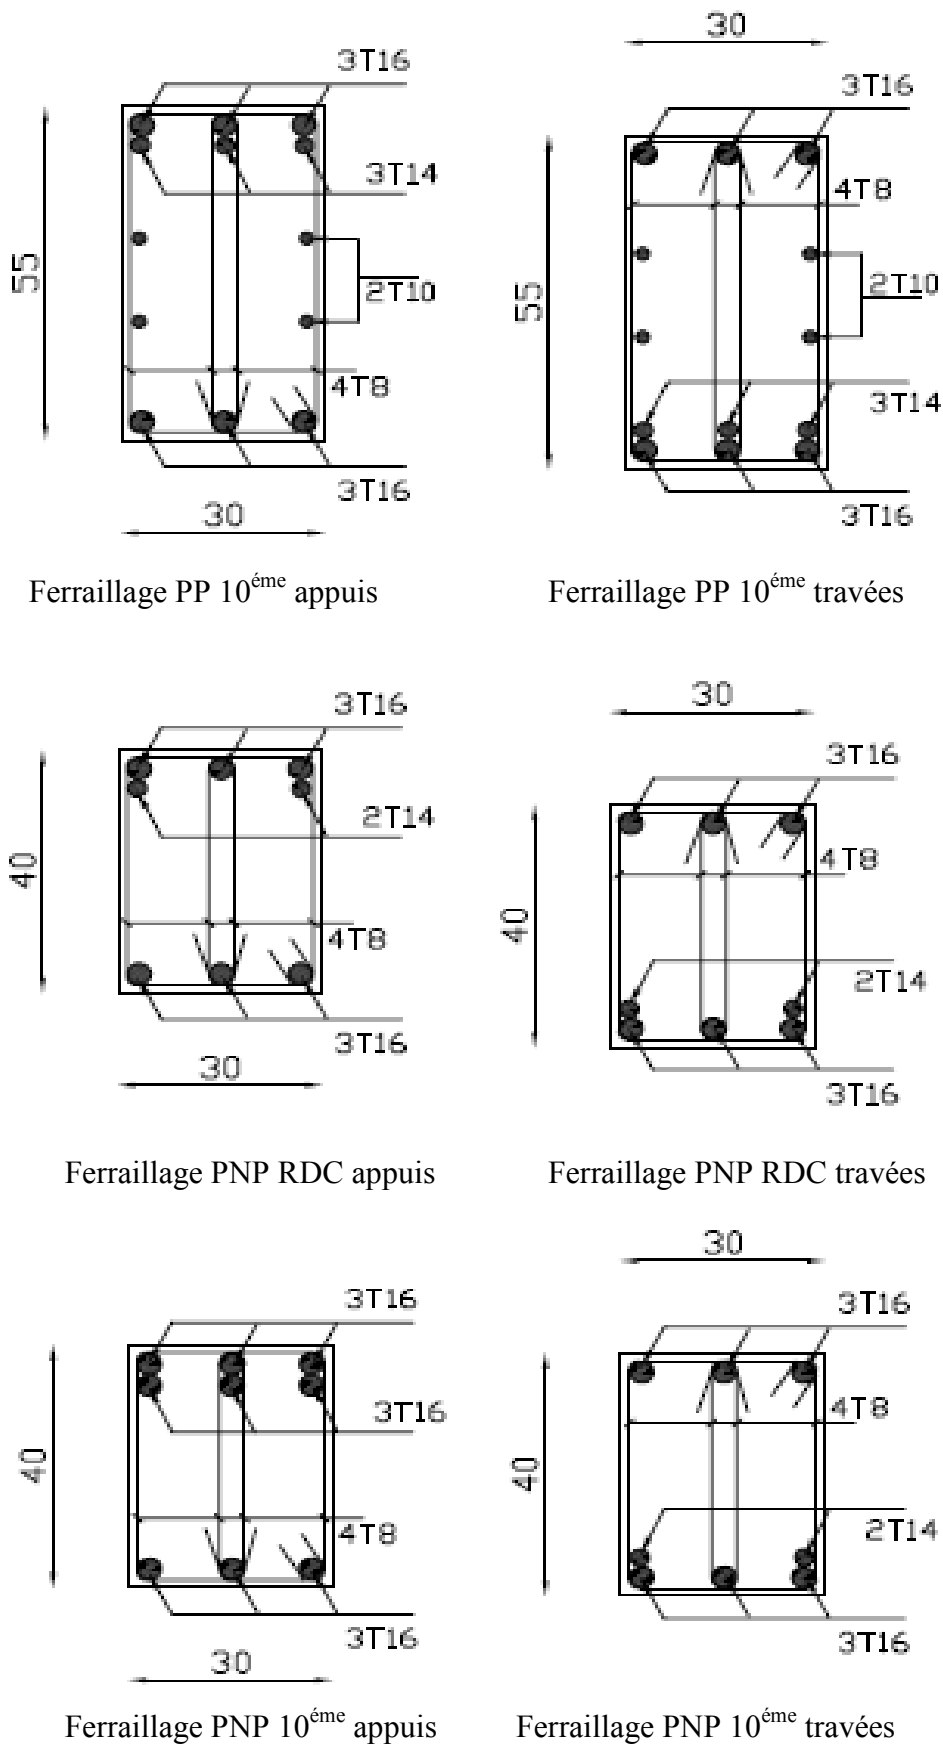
Exemples Schéma de Ferraillage des Poutres.
